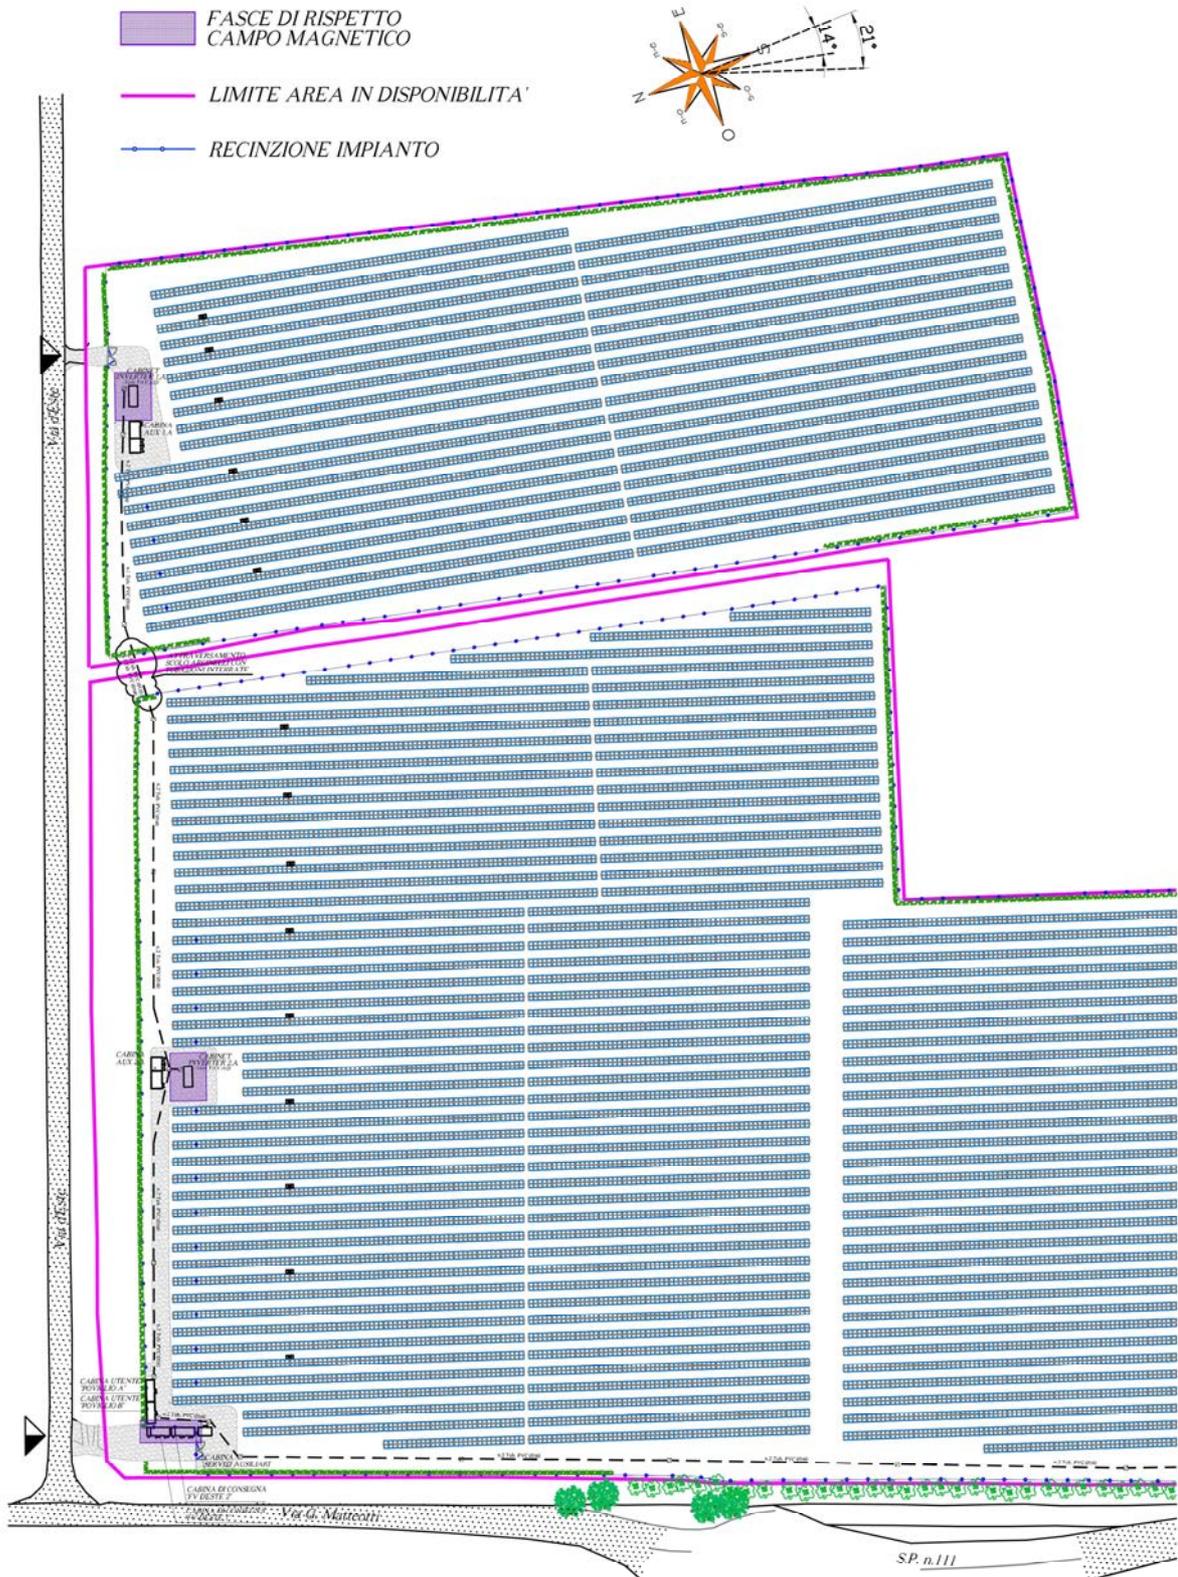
Planimetria individuazione fasce di rispetto determinate - zona nord
